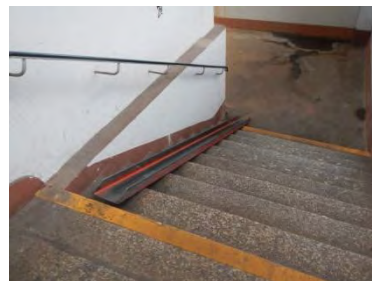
Mängel: große Anzahl (tw. verbogene) Vorderradklemmen, schmale Rampe
